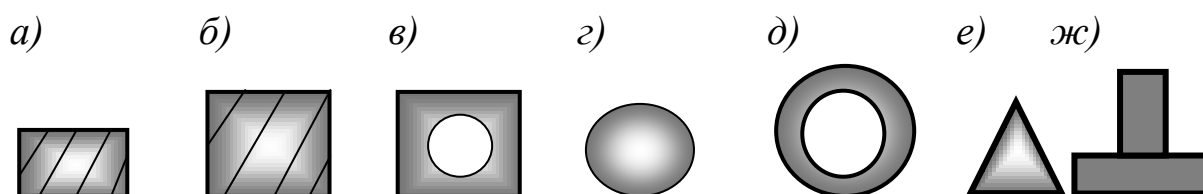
Варианты форм поперечного сечения железобетонных свай:
